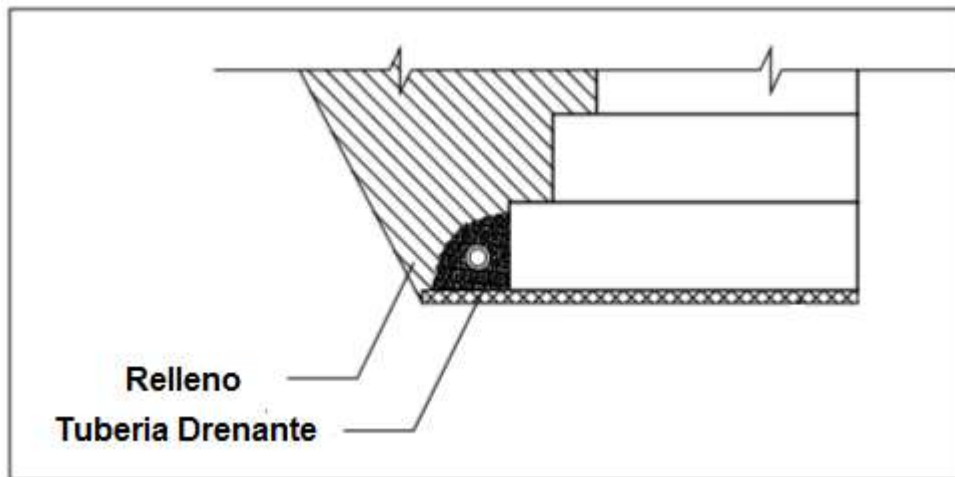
Representación de un sistema de drenaje con tubos drenantes,
